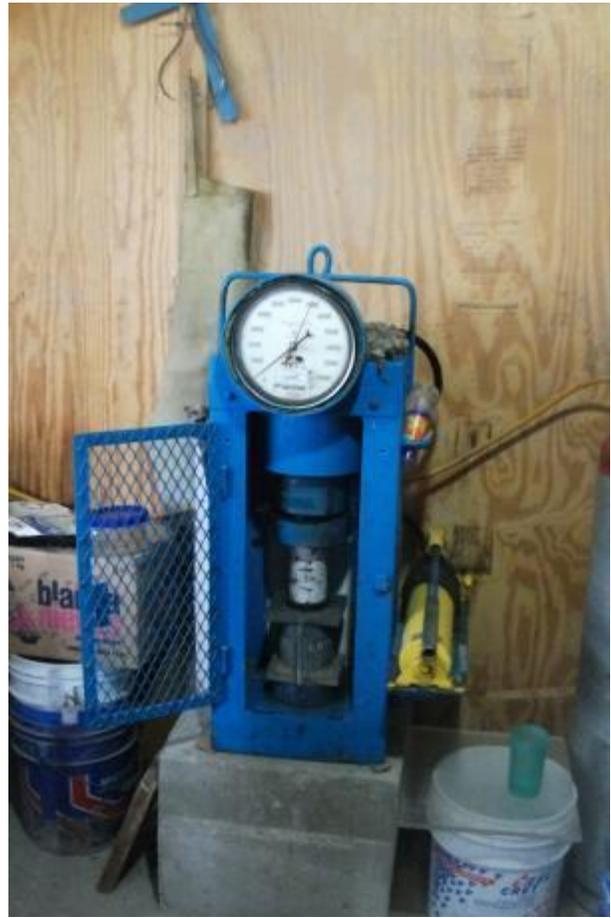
41 Pruebas a especímenes de concreto obtenidas durante la colocación de concreto lanzado
